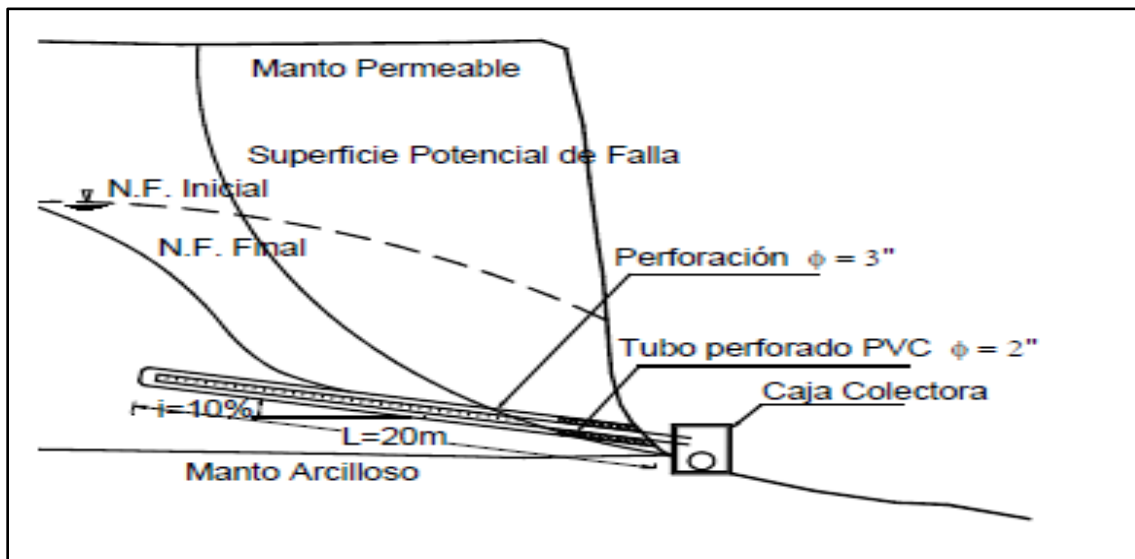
Detalle Típico de subdren horizontal o de penetración.
